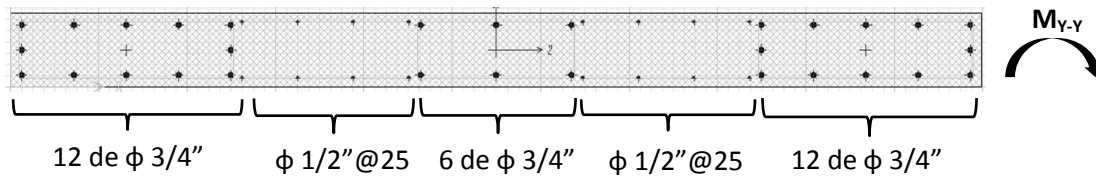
Armado preliminar por flexión para la placa del ejemplo.
